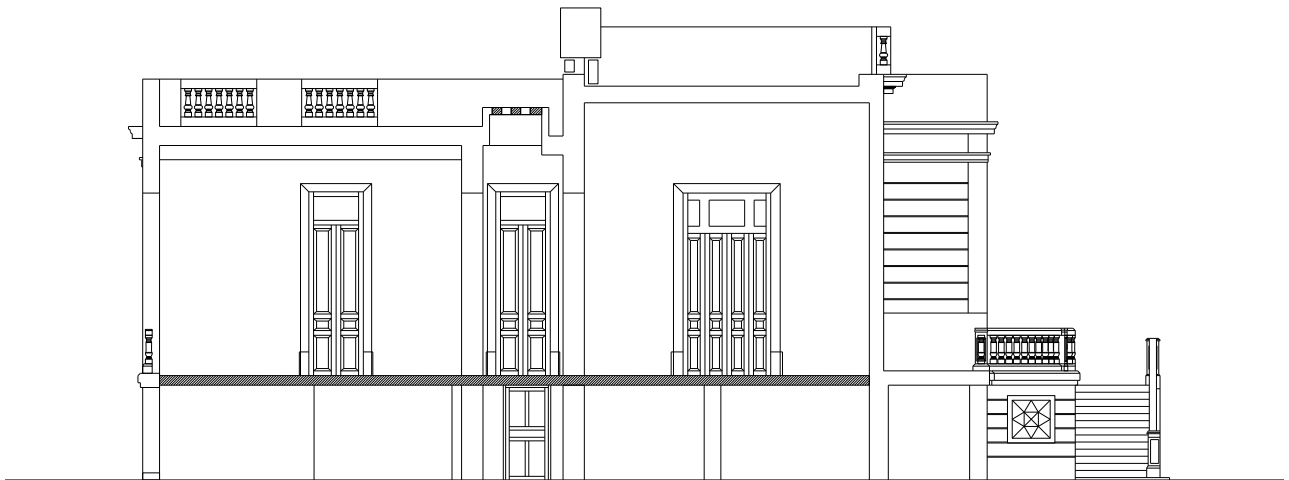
Corte Transversal, Proyecto de Restauración de la Casa del Lago.
